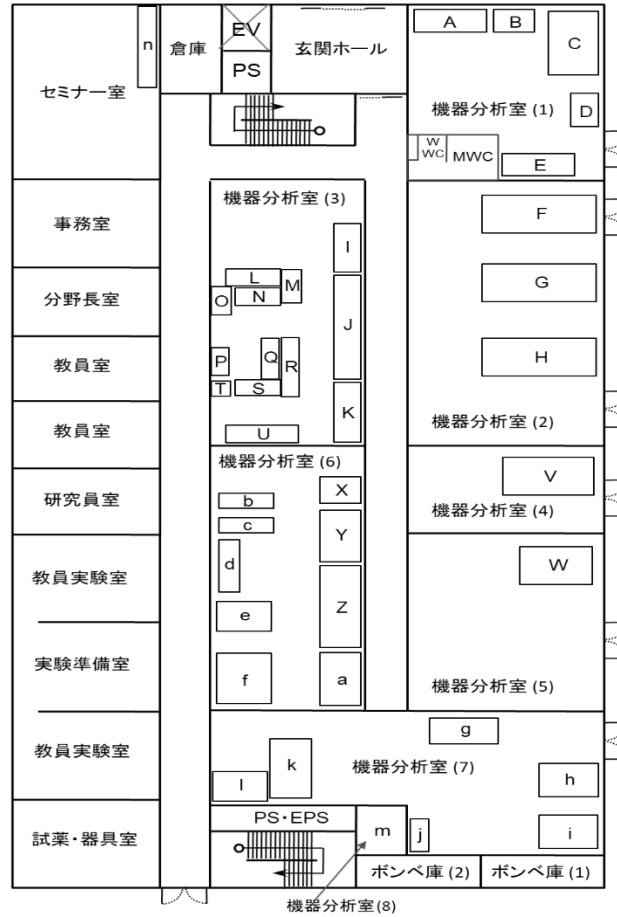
総合研究棟Ⅱ 1階 機器配置図
